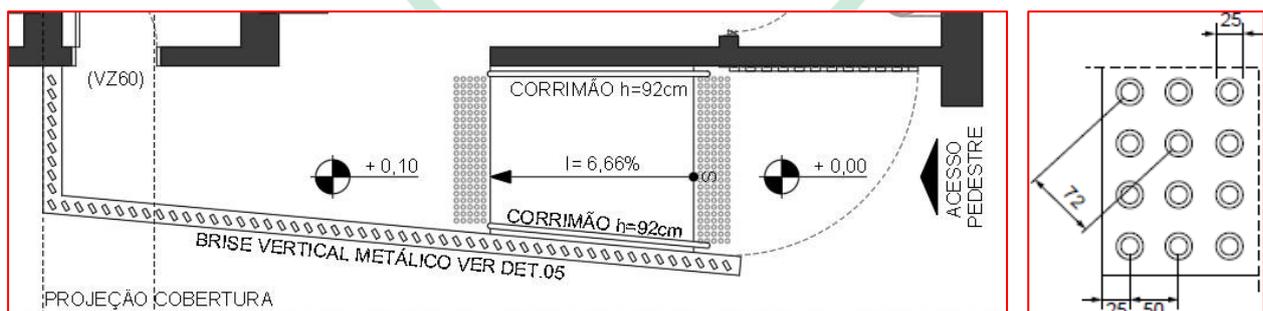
Detalhamento do piso tátil a ser instalado - CEASA/PR e AUE
